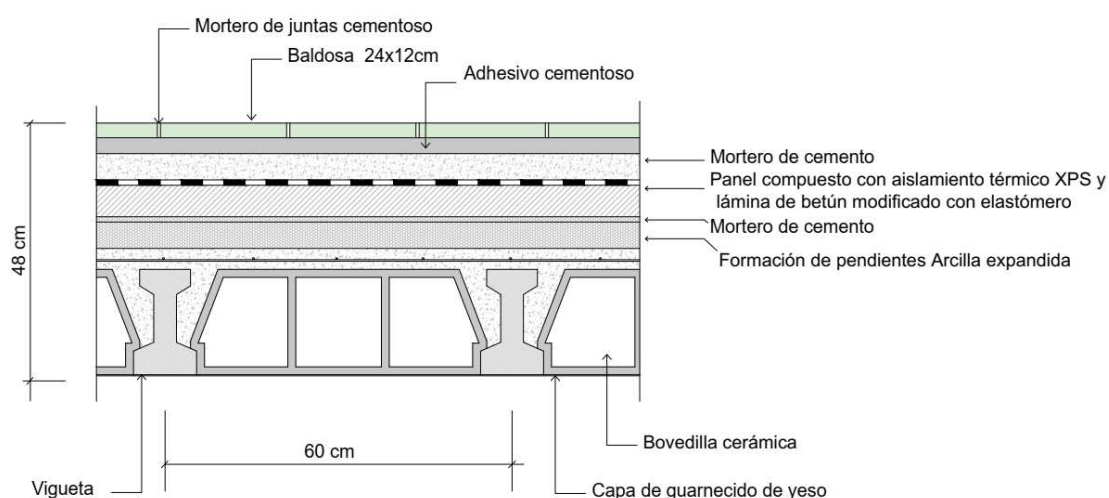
Detalle sección cubierta plana transitable. Fuente propia programa AutoCAD
